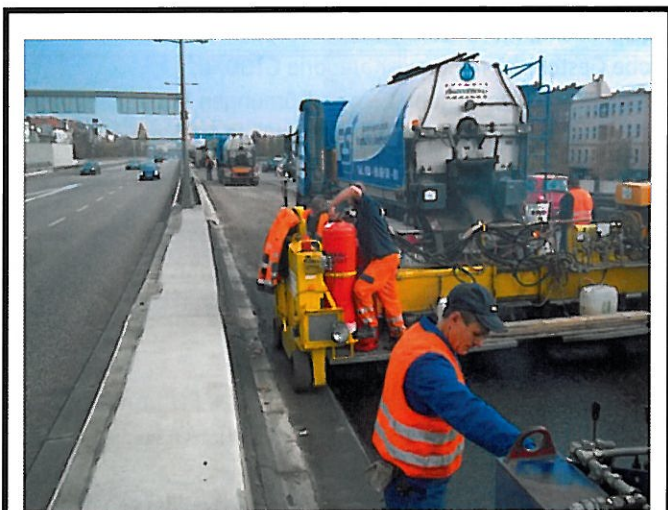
und 8: Einbau Gußasphalt auf Ingenieurbauwerk mit Einbaubohe und Abstreuerung
